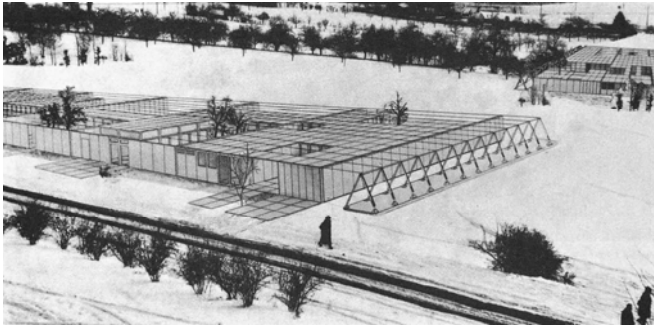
Willi Ramstein. Sistema de viviendas flexibles en hilera con estructura tensada de cubierta. Modelo y planta. (G.R., 1963)
